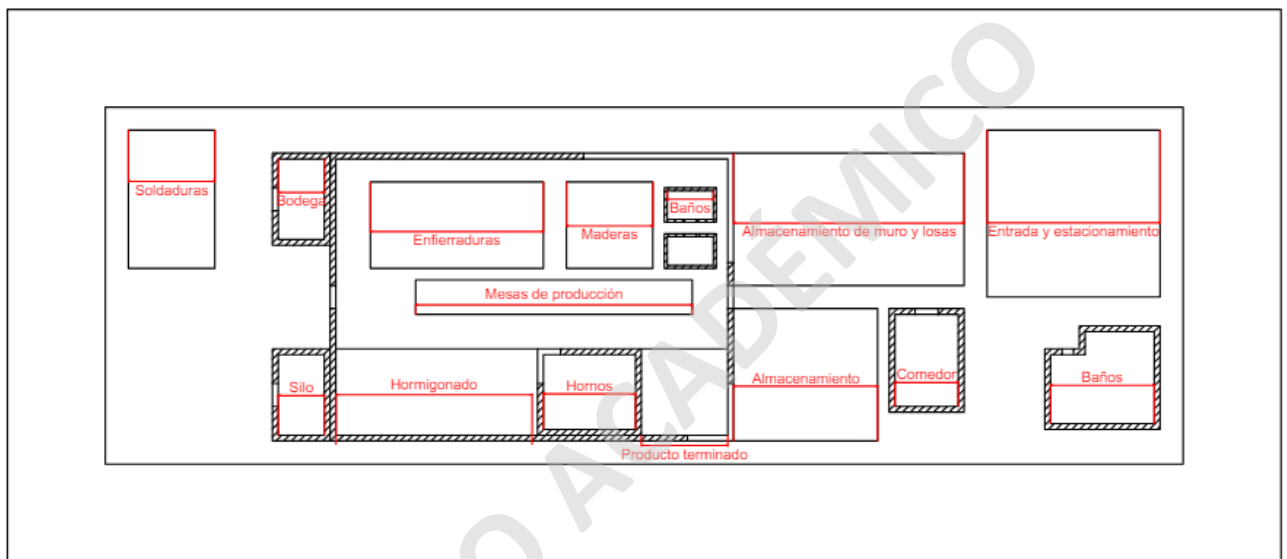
PLANO ESTRUCTURAL DE PLANTA
